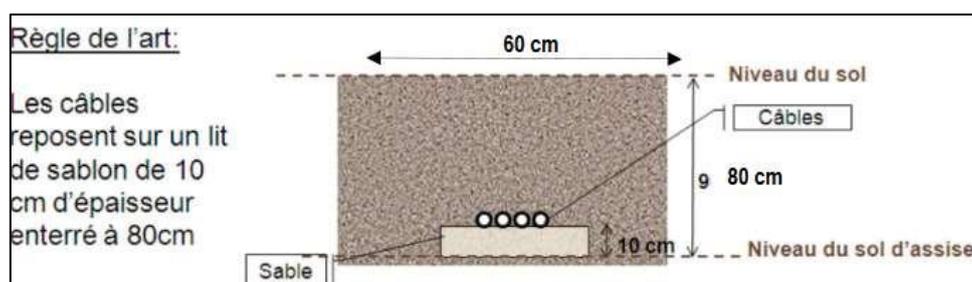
Coupe type d'une tranchée au sein du projet (source : Internet).
